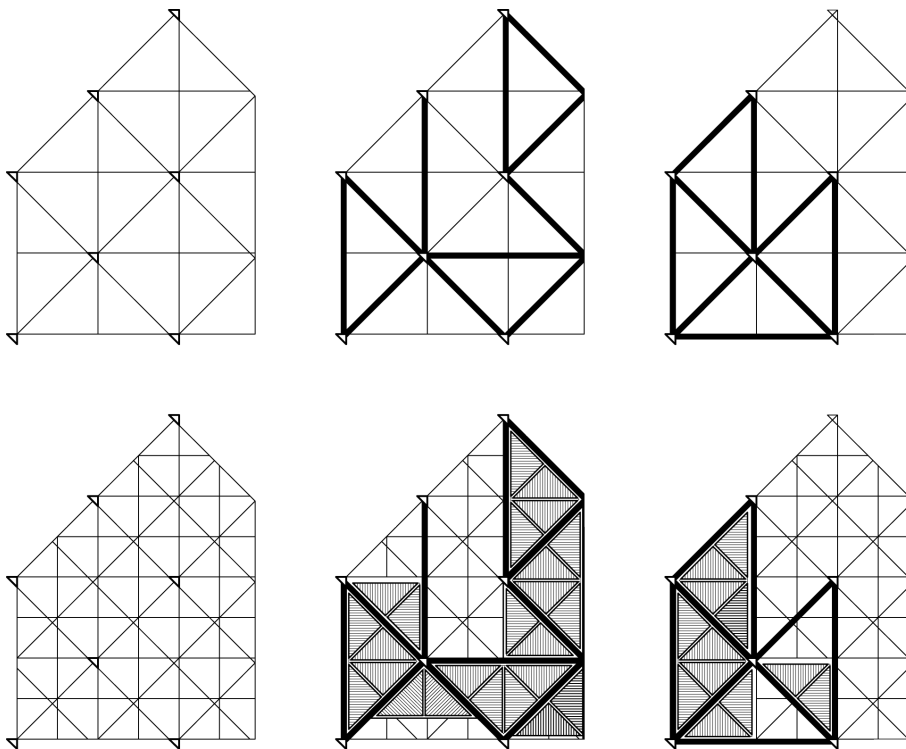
Vigas e Lajes, Pavimentos 2 e 3.
